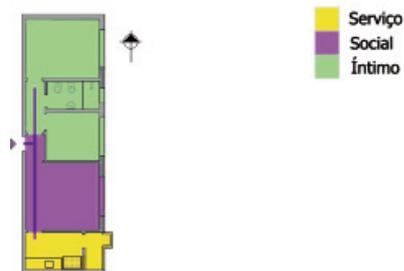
Planta baixa dos fluxos do Ed. Paraíso
